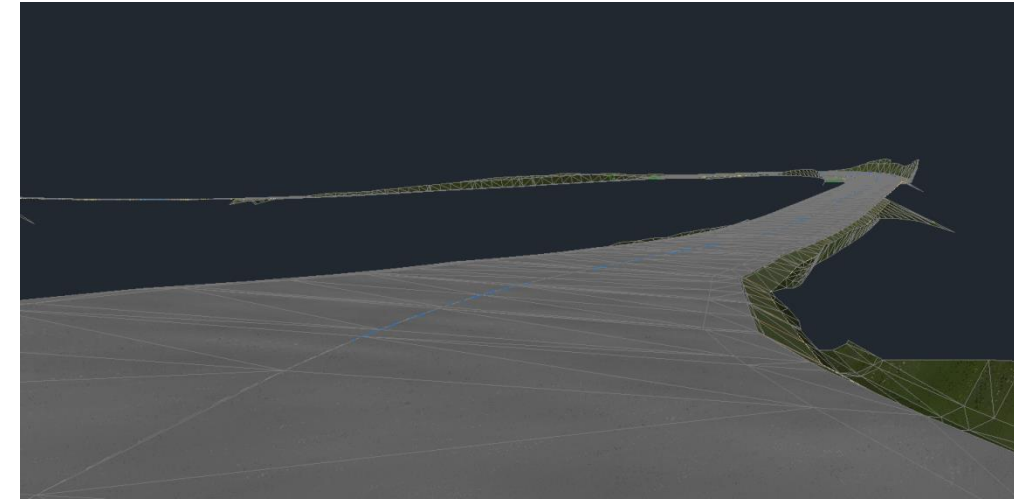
Coordinación planta-alzado. Sentido creciente. PK 0+560
